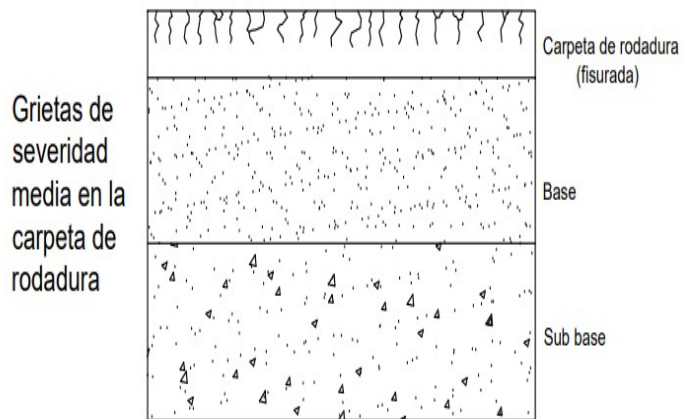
Pavimento flexible con fisuras en la carpeta de rodadura
